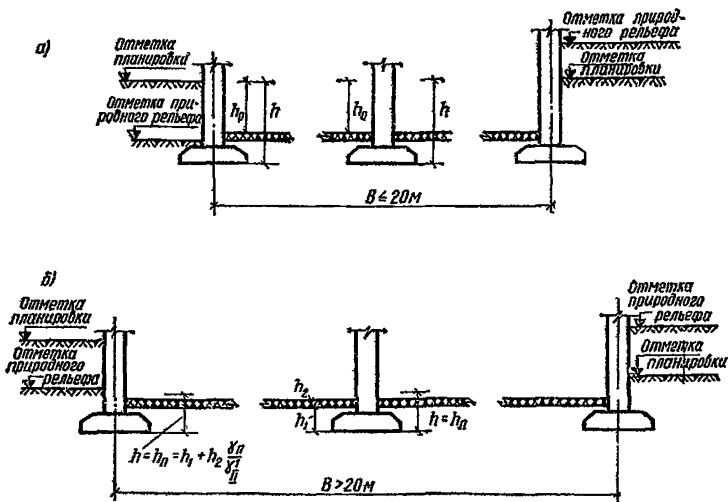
Схема принимаемой в расчете глубины заложения фундаментов зданий при определении расчетного давления на основание R по формуле (3.38) (17)
